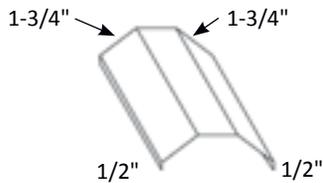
Tapajuntas de cubierta para el sistema de cumbrera ventilada #211 (#211 Vented Ridge Cap Flashing)
